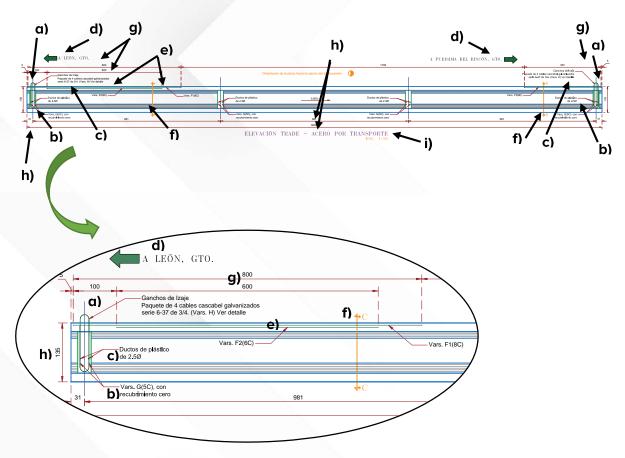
ejemplo de detalle de acero por transporte de la trabe (elevación)
